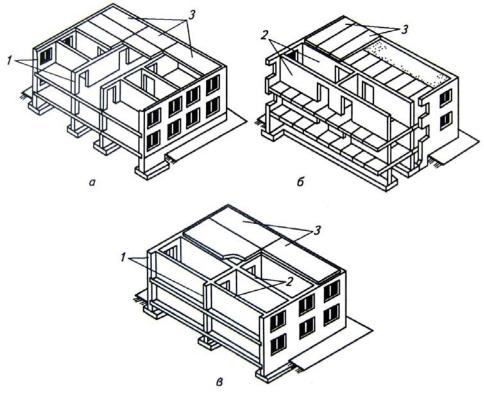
Конструктивные схемы бескаркасных зданий: а – с продольным расположением несущих стен; б – с поперечным расположением несущих стен; в – перекрестная; 1 и 2 – продольные и поперечные несущие стены; 3 – плиты перекрытий
